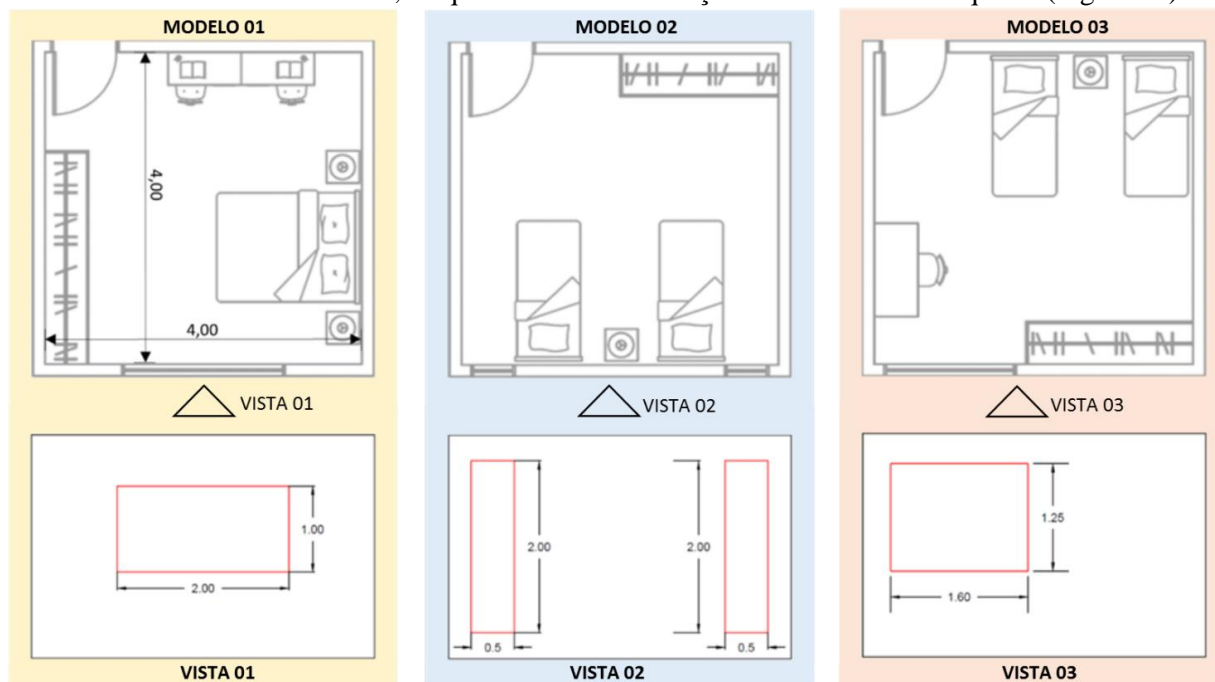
Planta baixa e vista frontal dos três modelos sugeridos para as aberturas.
